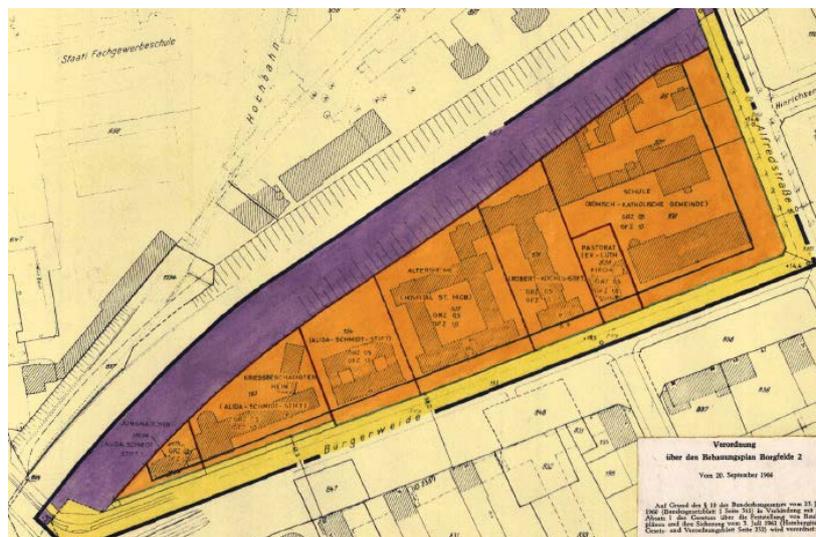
Ausschnitt Bebauungsplan Borgfelde 2 für den Bereich westlich Alfredstraße (Kartengrundlage © FHH, LGV)
